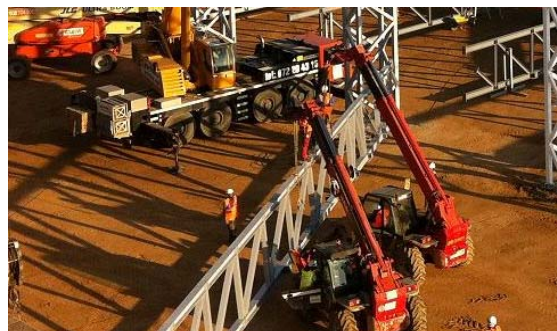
MAQUINARIA TODO TERRENO ELEVADORA
